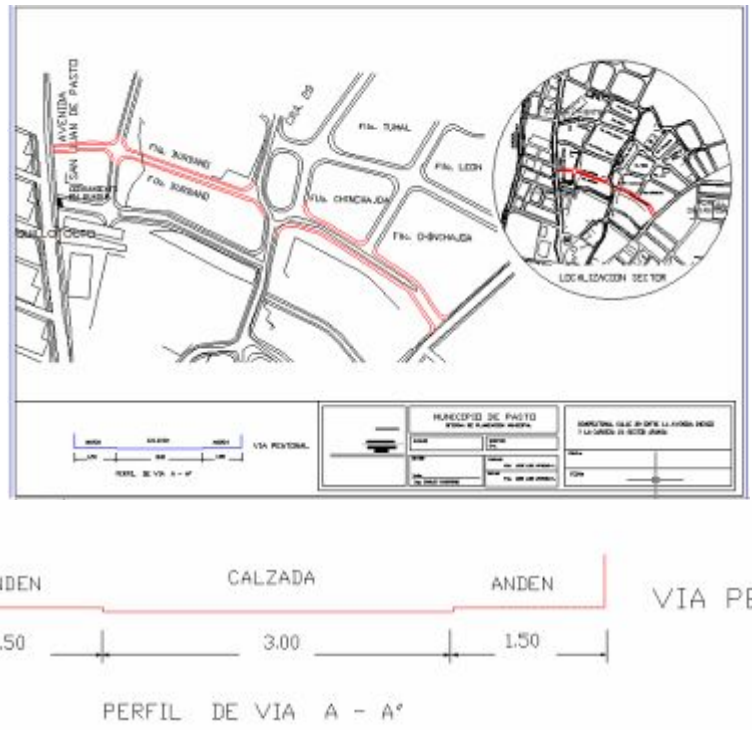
Planta y sección transversal calle 37 entre Avenida Inesco y carrera 26
